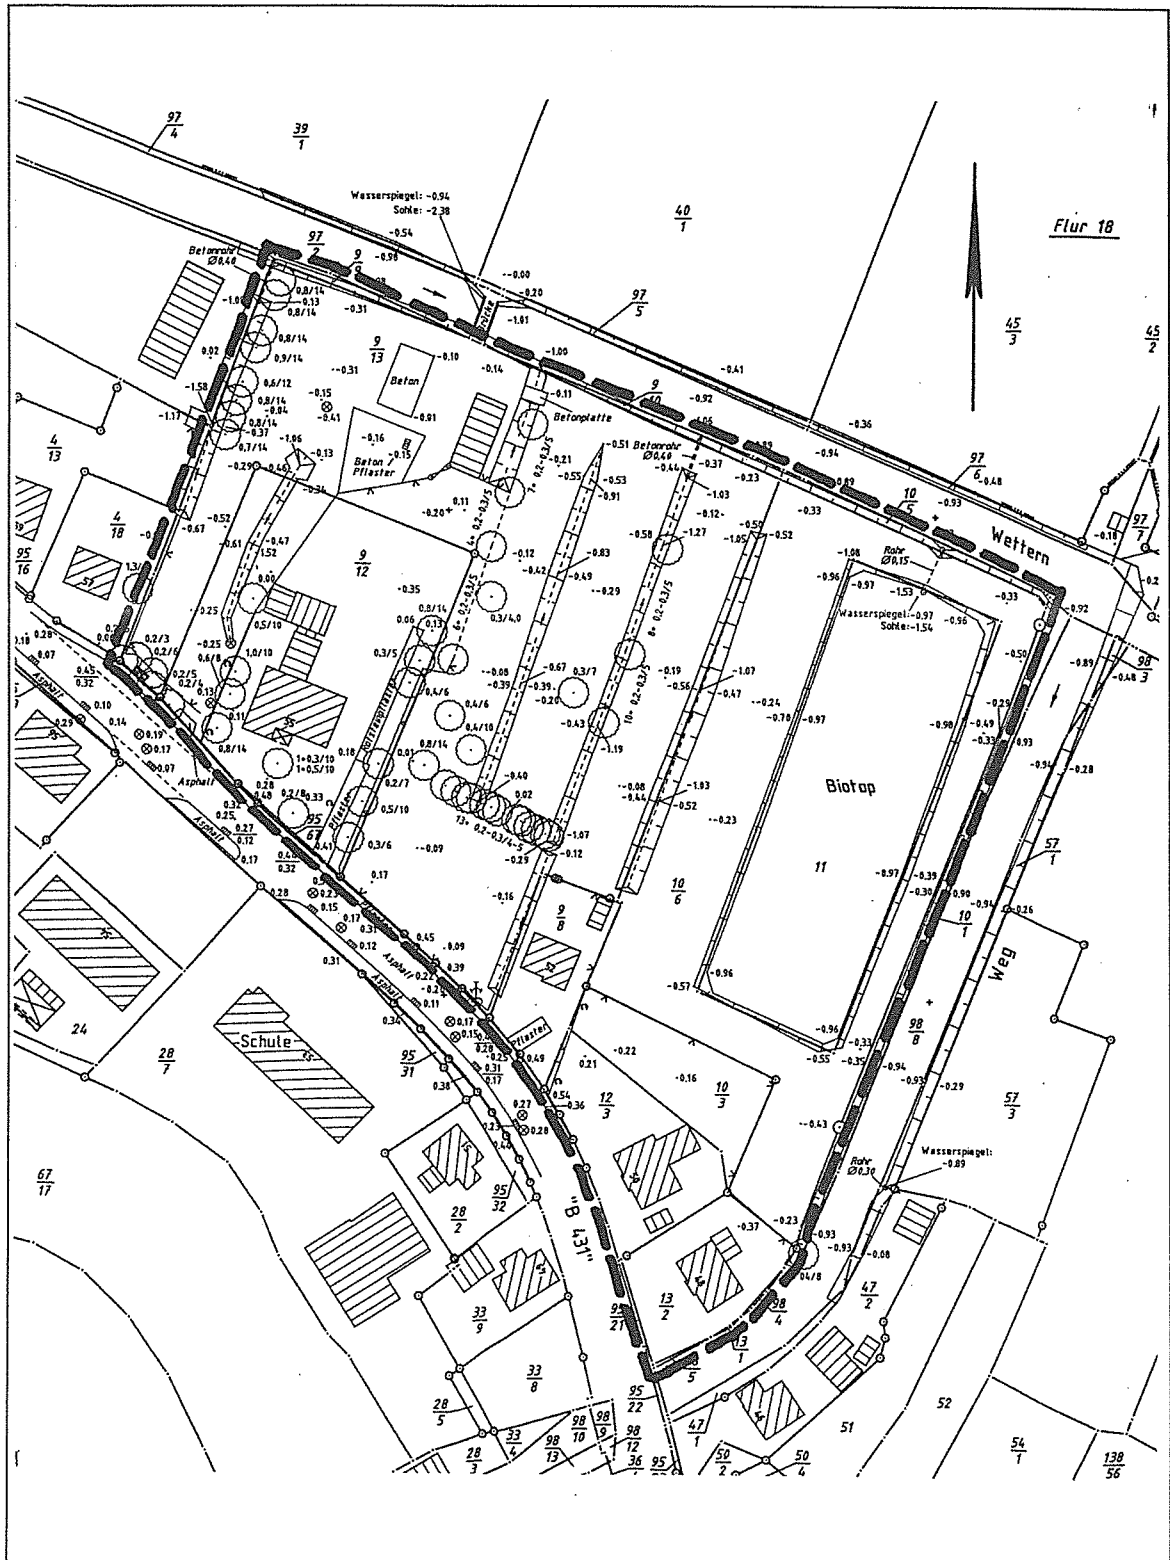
Abgrenzung und Lage des Plangebiets zur vorhandenen Siedlungsstruktur beiderseits der „Dorfstraße“ auf Grundlage der amtlichen Planunterlage v. 05.04.2001, unmaßstäblich
